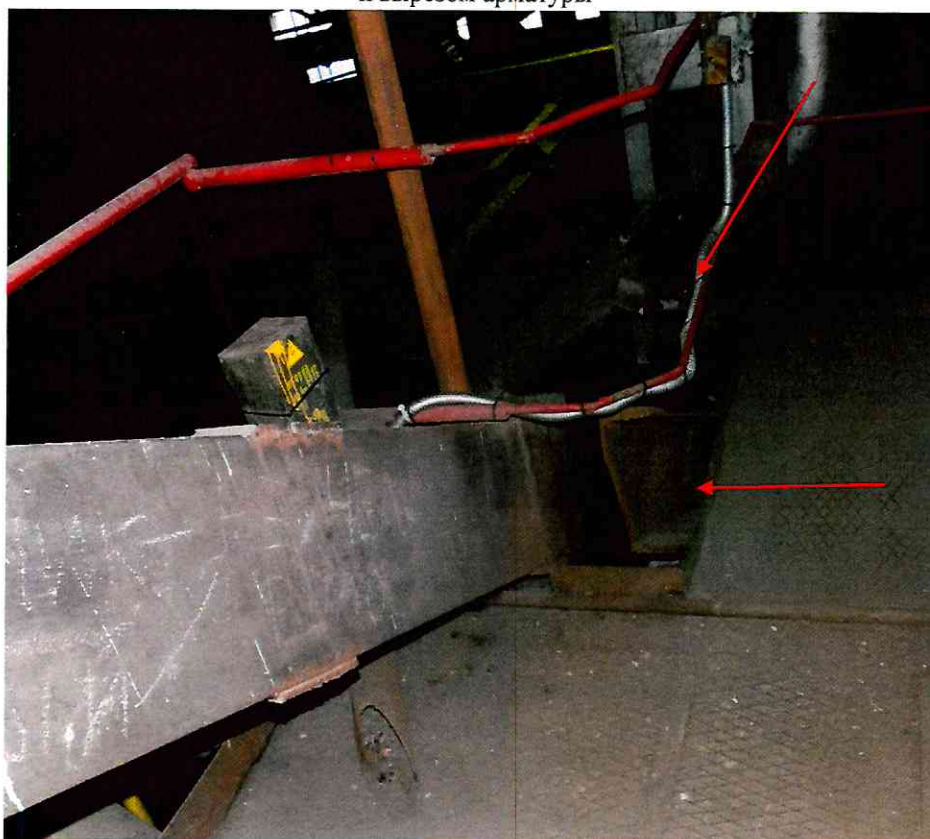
Ферма перекрытия на отм. +18.300м в осях 10'-9'/И. Вырез раскосов и стойки металлической фермы перекрытия
